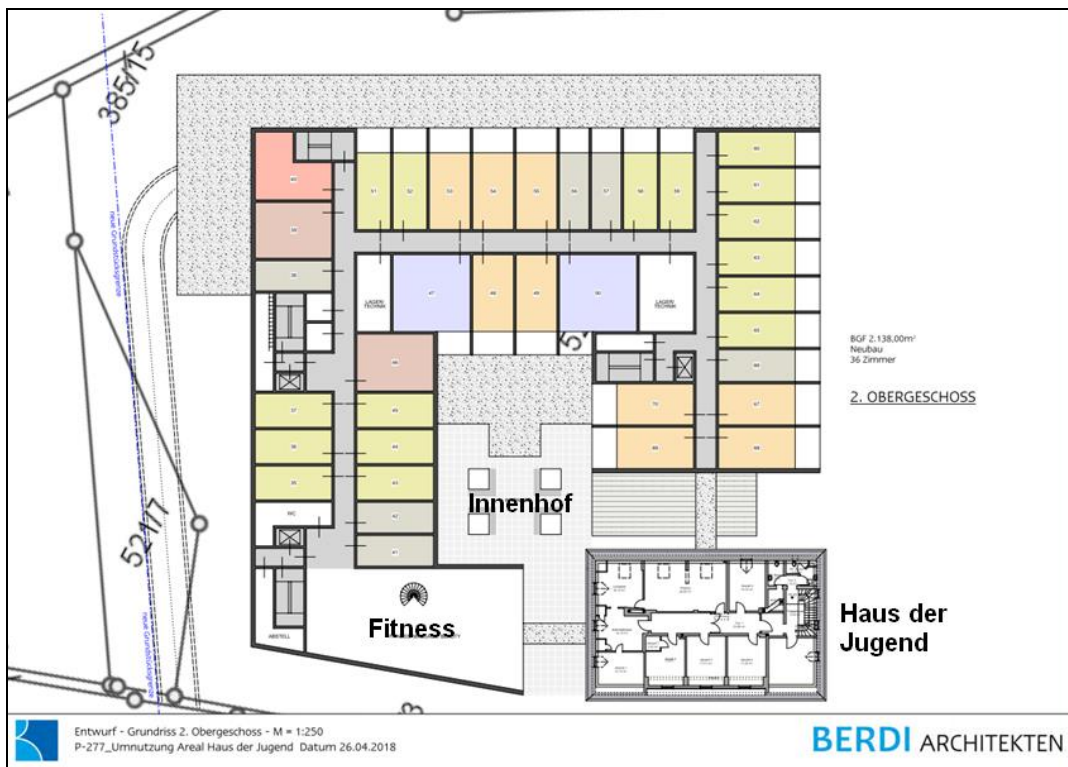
Grundriss 2. Obergeschoss (Hotelzimmer/Fitnessraum)
